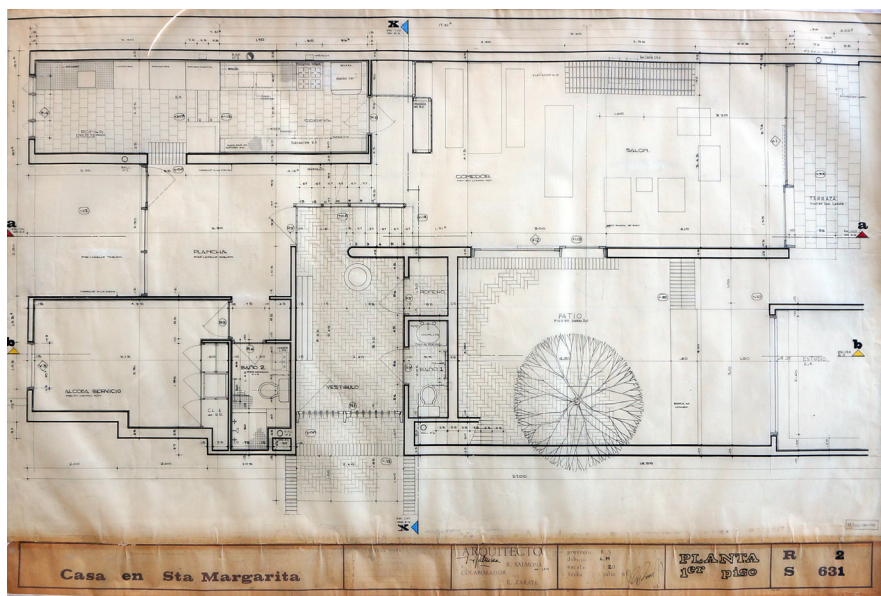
Casa en Santa Margarita- JR Z002-01D-044 (julio 1965)-planta piso 1-E 1/20
